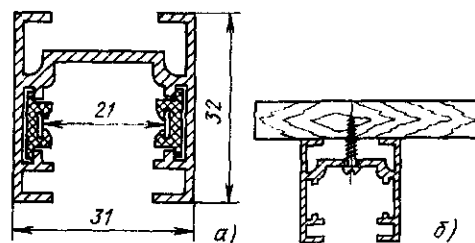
Поперечное сечение шинопровода ШОС80УЗ (а) и его крепление вплотную к плоским основаниям (б)
